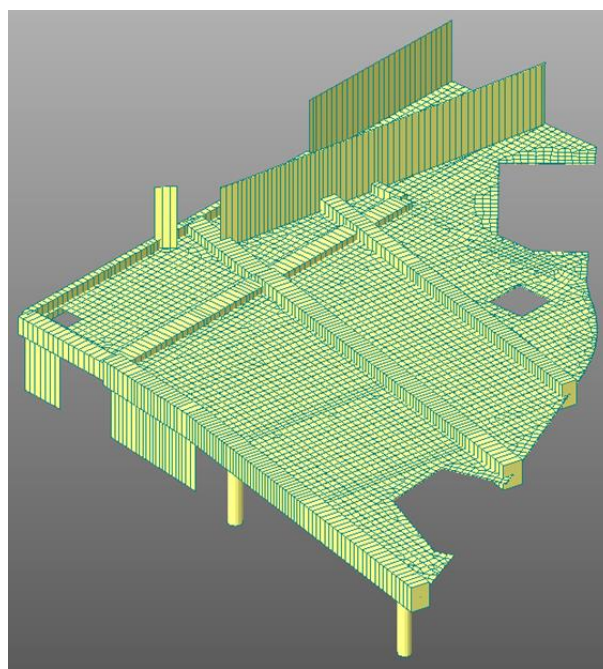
Disposizione planimetrica delle strutture portanti e, inizialmente, portate nella Piastra
